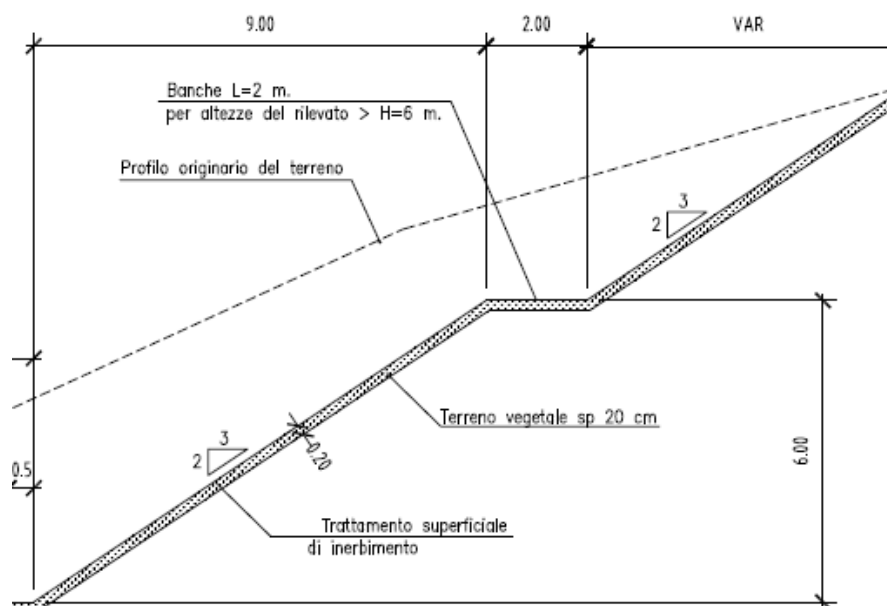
Stralcio della sezione tipo in rilevato con evidenziate pendenze e terreno vegetale
